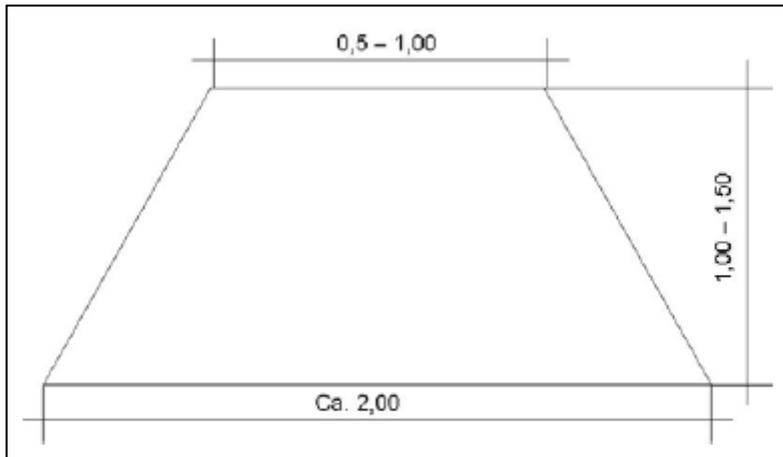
Querschnitt einer neu angelegten Wallhecke (Quelle: Landkreis Ammerland, 2015, alle Angaben in Metern aus der Broschüre Wallhecken).
